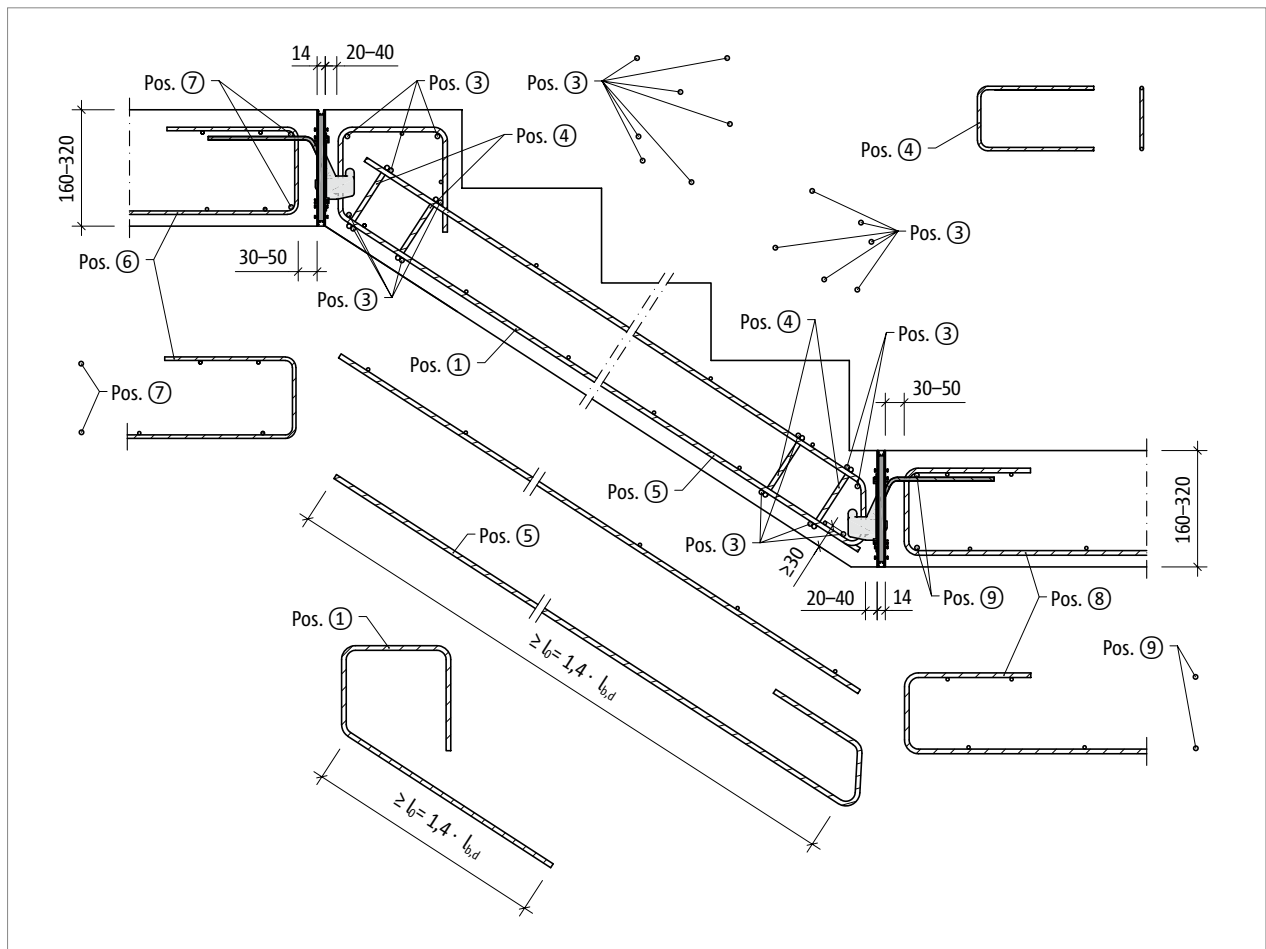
Schöck Tronsole® Typ T: Bauseitige Bewehrung
